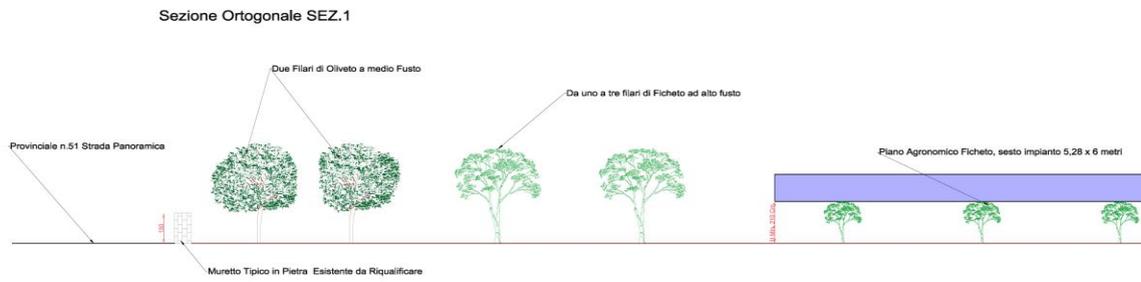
Piantumazione tra le file di tracker (SEZIONE)
